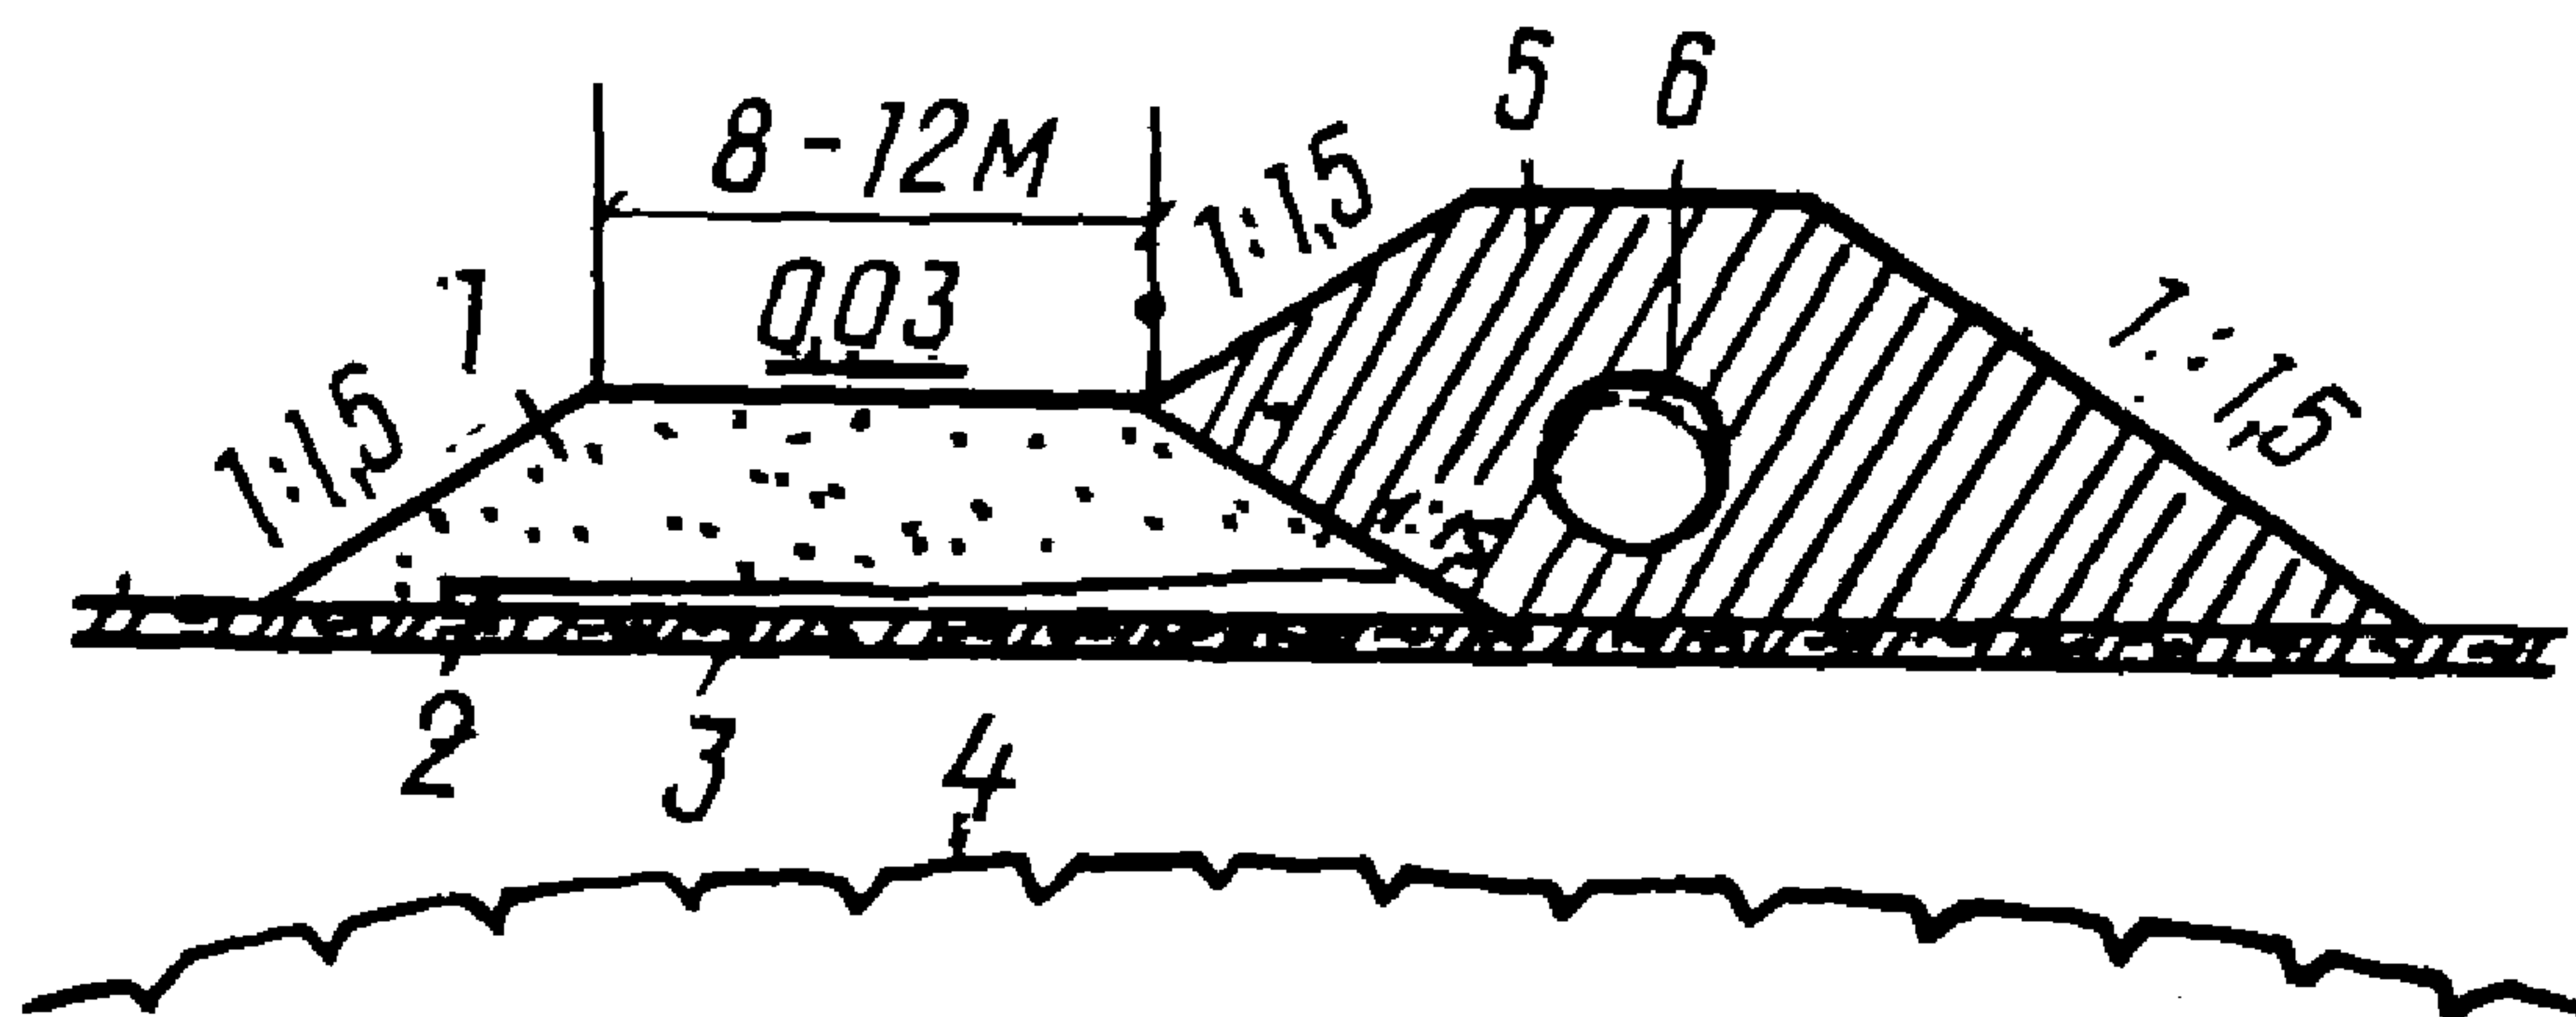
Поперечный профиль насыпи с хвостяной выстилкой на участках четвертой группы ландшафтных комплексов при наземной прокладке трубопровода:
